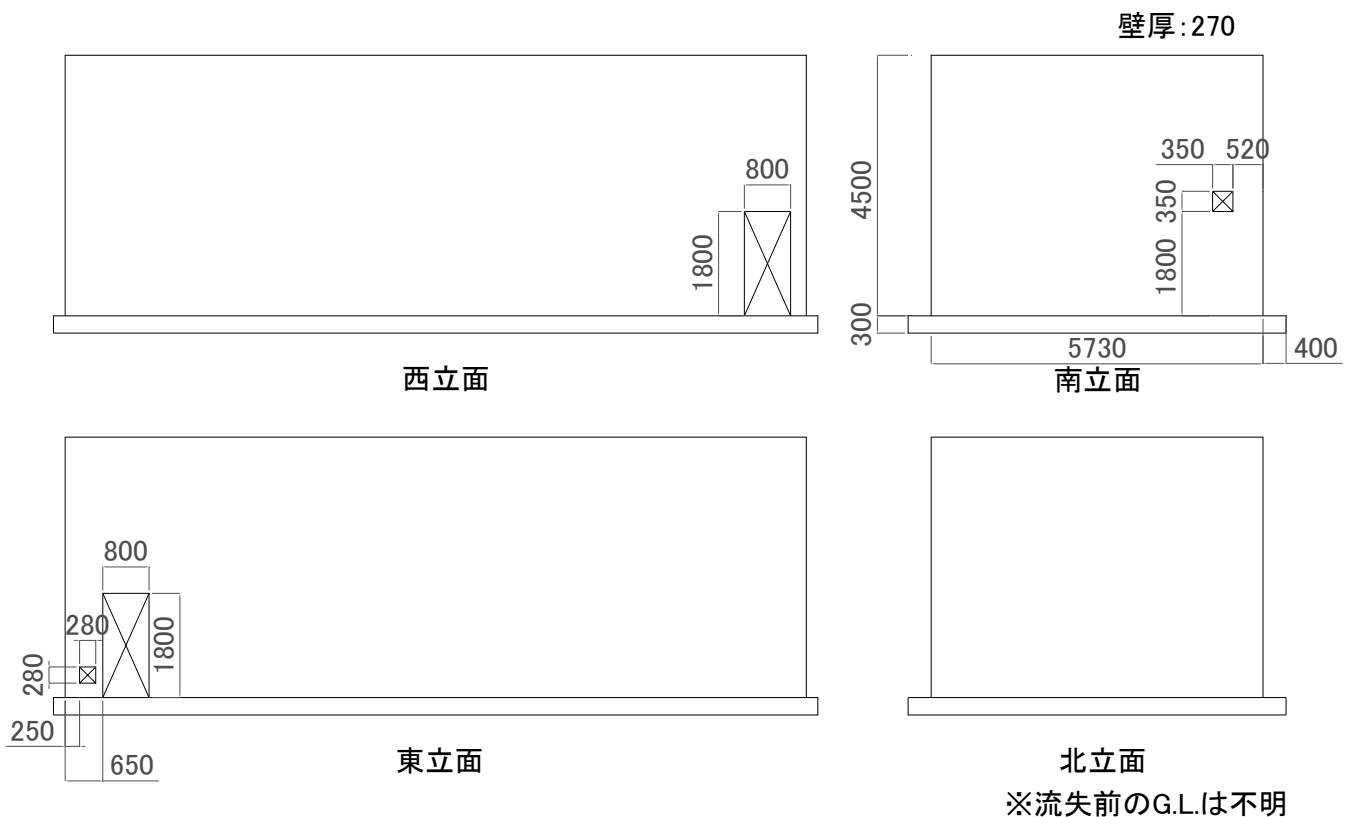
汚水処理層の立面図（単位：mm）
